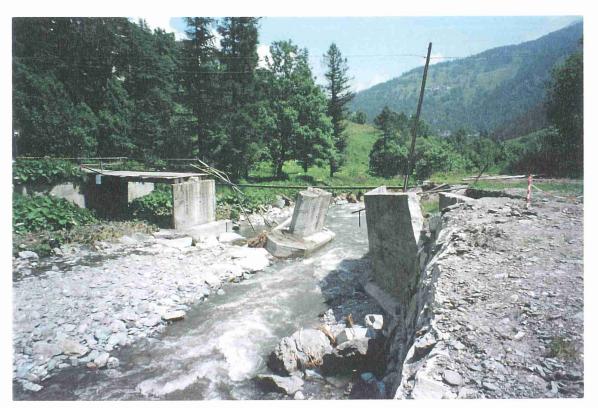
Torrente Germanasca - Comune di Praly – Località Ghigo Il ponte di accesso alla Frazione Orgere, in calcestruzzo e legno, è stato scalzato e distrutto in spalla destra mentre la pila centrale è stata ruotata (a causa delle fondazioni molto superficiali).
